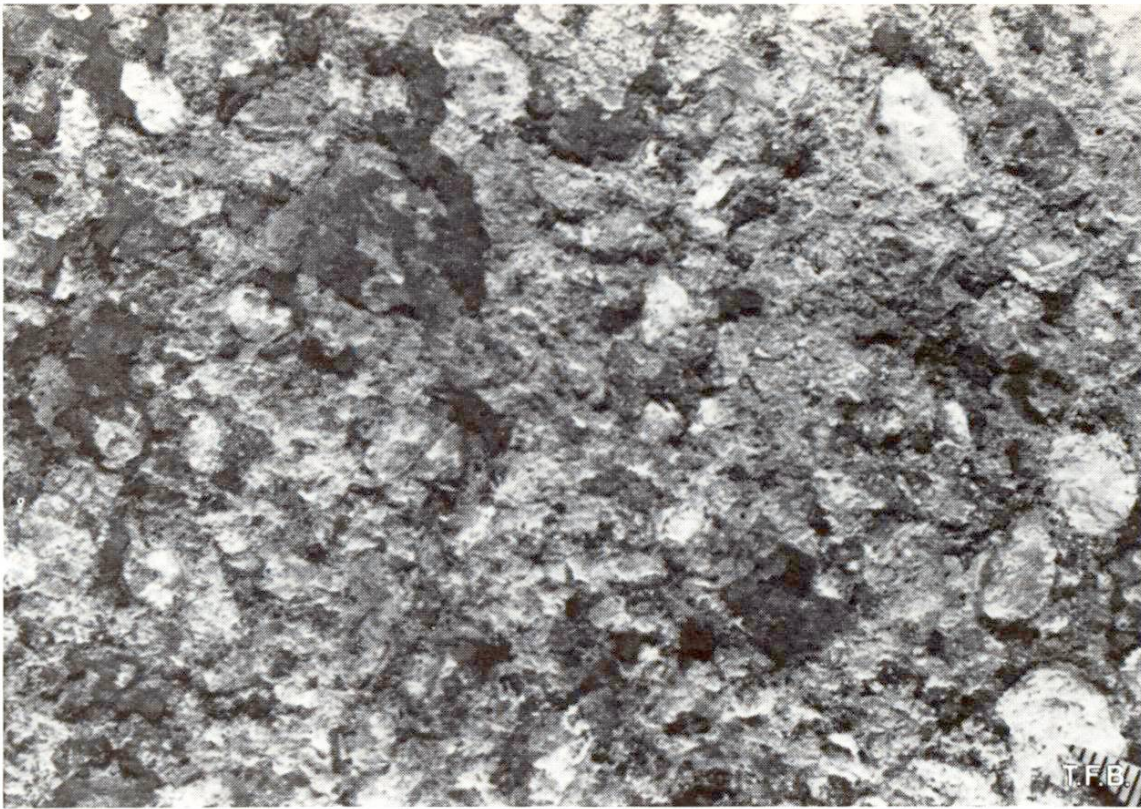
Betonoberfläche ähnlich Abb. 4 nach der Behandlung. Wenige Reste des Gummieabriebes verbleiben in den Vertiefungen der Betonoberfläche.
